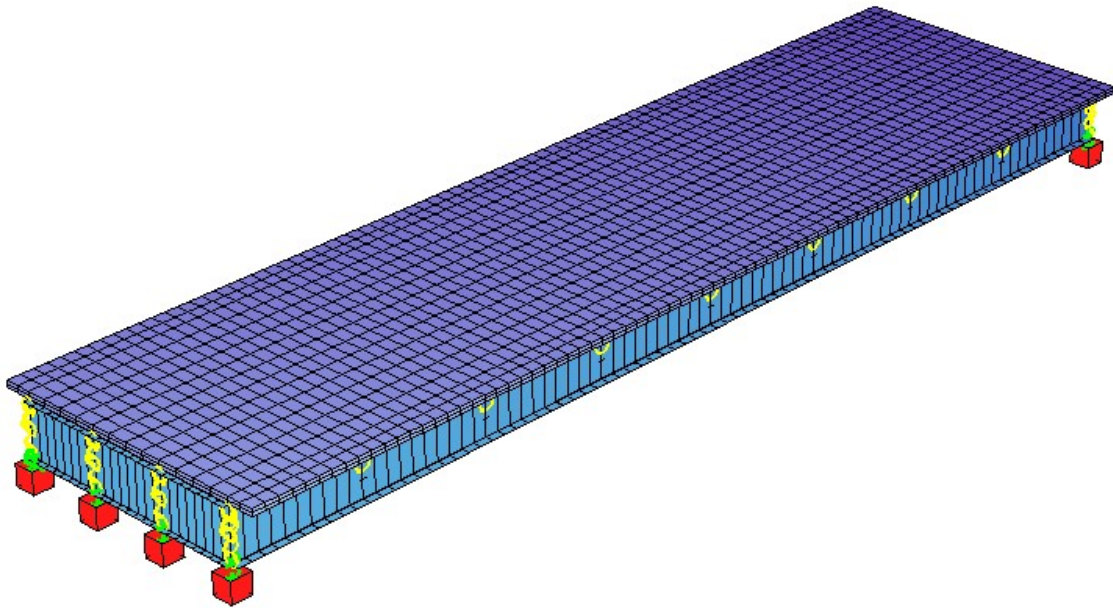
Betoniranje polja kod proste grede bez podupiranja, Sofistik
